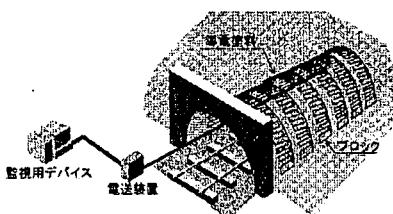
ひび割れ検知システムのイメージ⁶⁾
